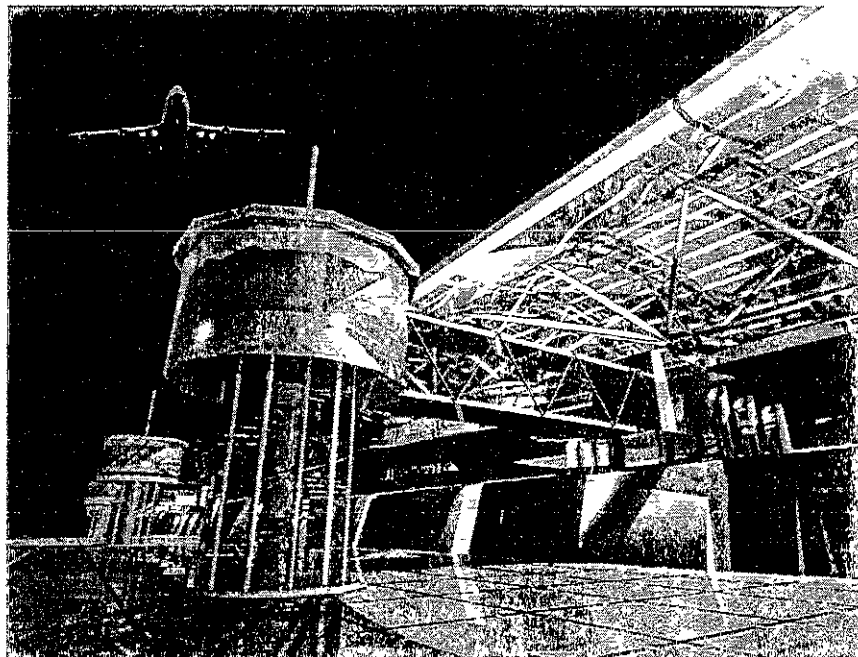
Proyecto de Aeropuerto (exterior) desarrollado en AllPlan
